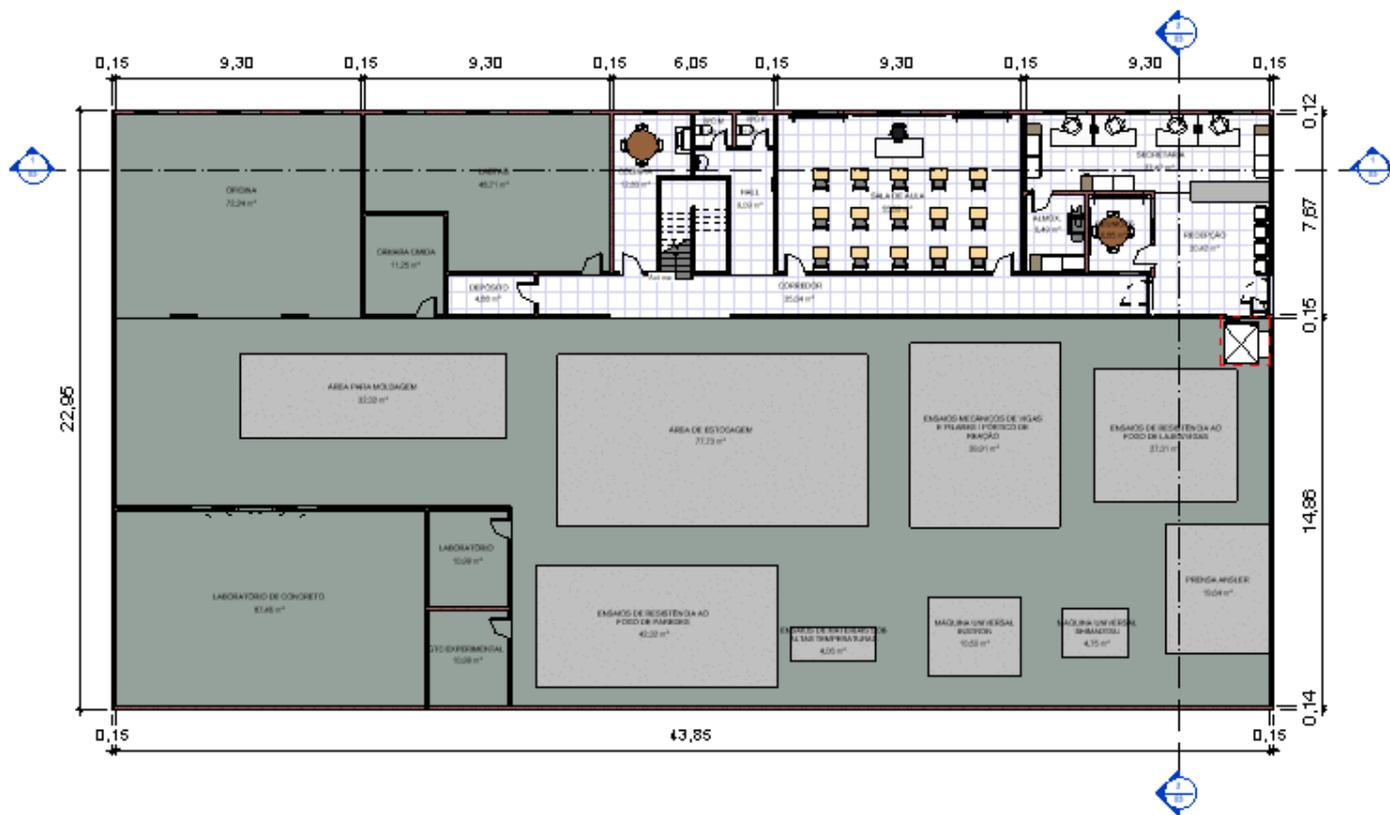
Planta Baixa do Laboratório de Análise Estrutural e de Materiais do DECIV/CTG/UFPE – Cortes
